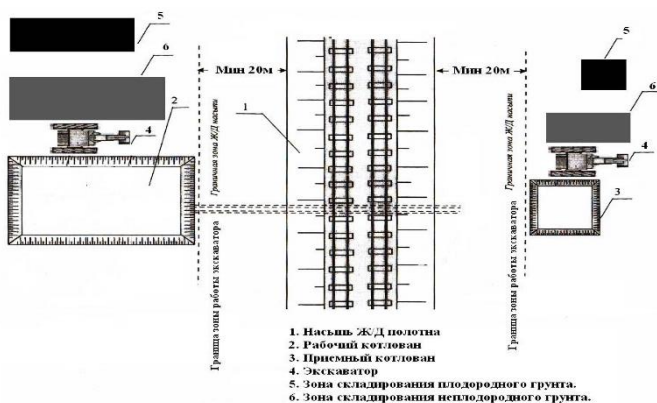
Технологическая схема работ по планировке рабочих площадок и отрывке котлованов
